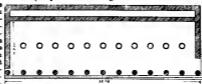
Grundriß der Attaloshalle, rekonstruiert (1:400).
